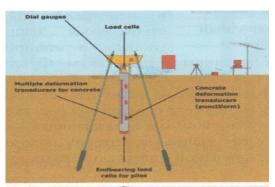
Традиционный метод проведения испытания свай нагрузкой до 60 МН с приложением нагрузки сверху вниз
